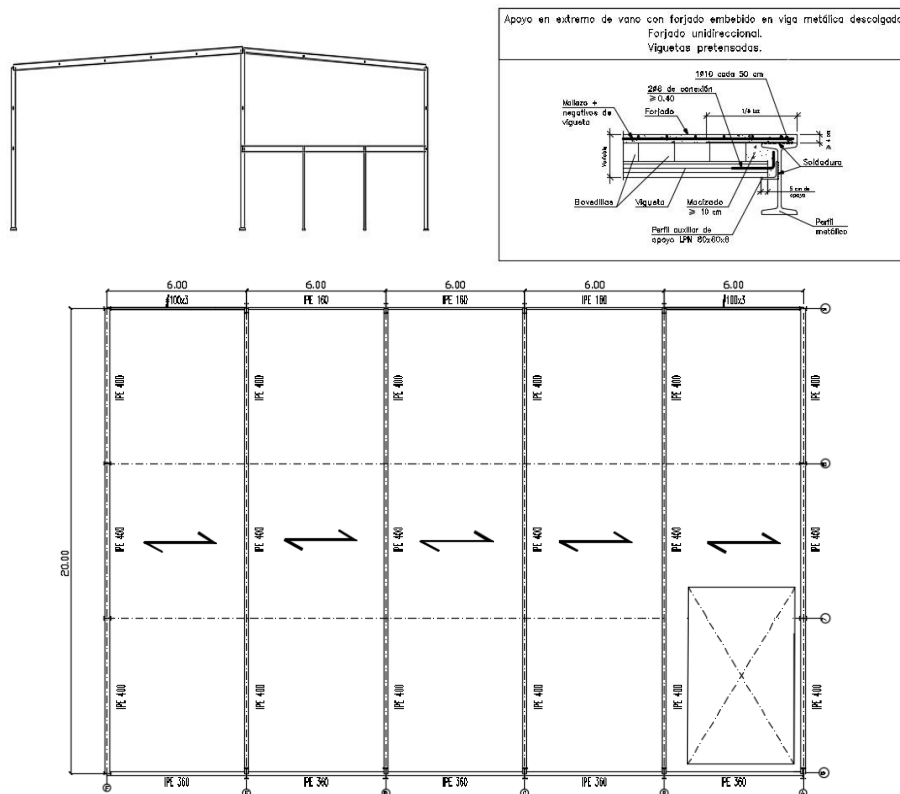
Forjado y apoyo de placa alveolar en viga metálica. (Fuente: Creación Propia)
